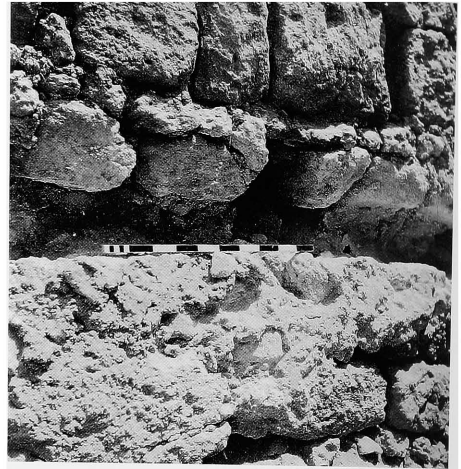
Palais Nord. Mur II/XVII, face sud-ouest : emplacements d'un chaînage longitudinal et d'un chaînage transversal (1981).
